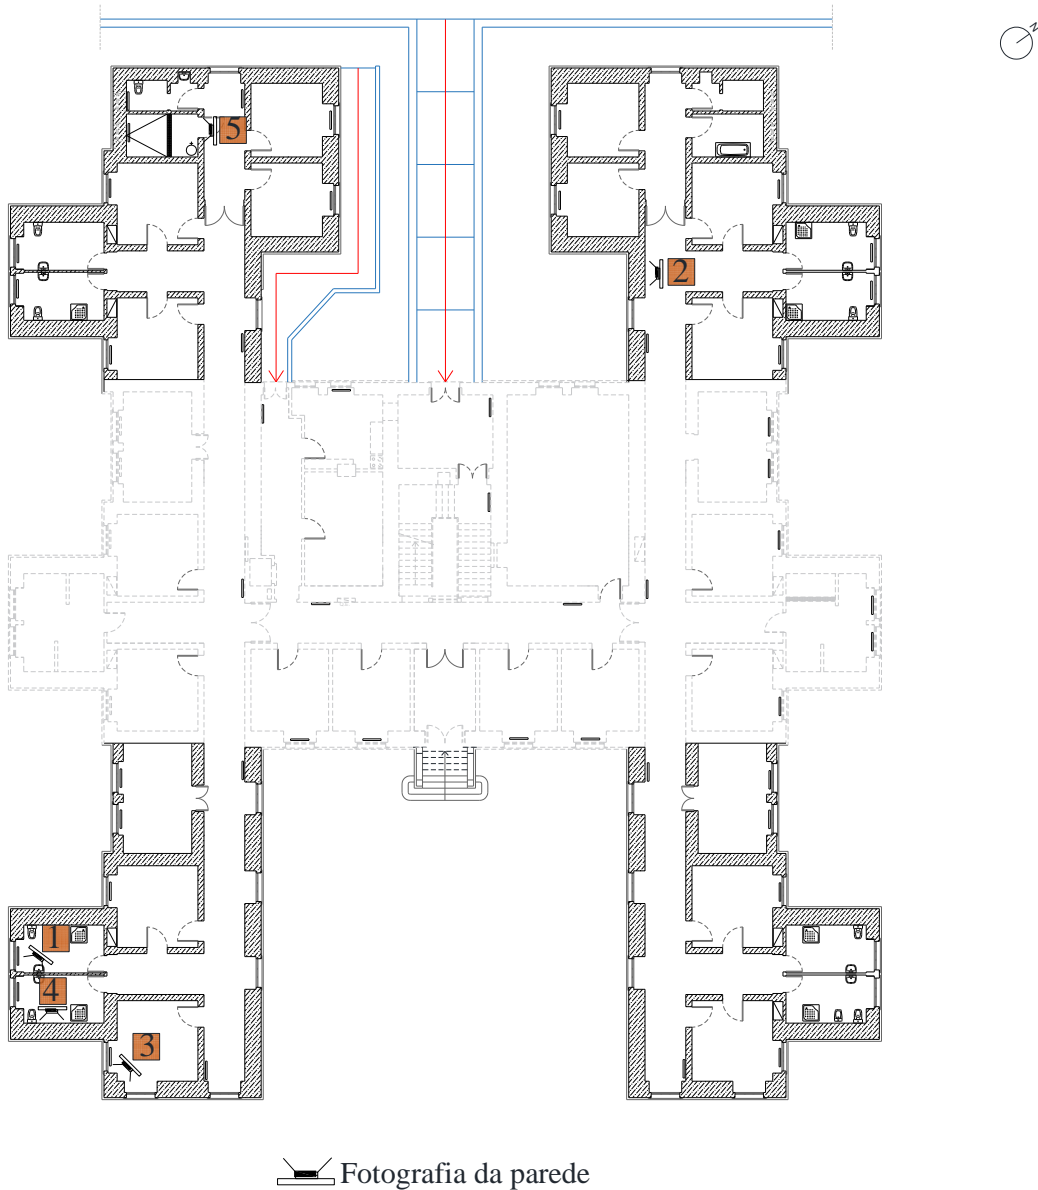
Localização das Imagens 📷, na planta do Piso 0 [Fonte: Planta cedida pelo C.H.J.M]
